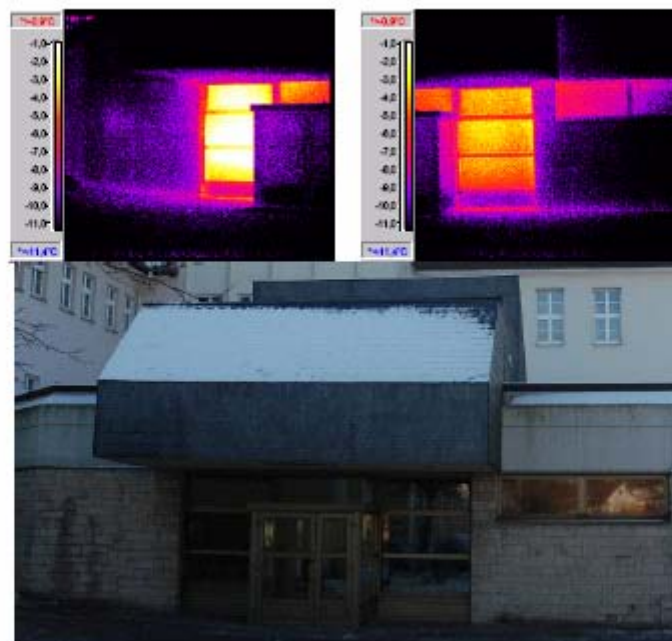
Hauptgebäude Rückseite, Eingang Flachbau
